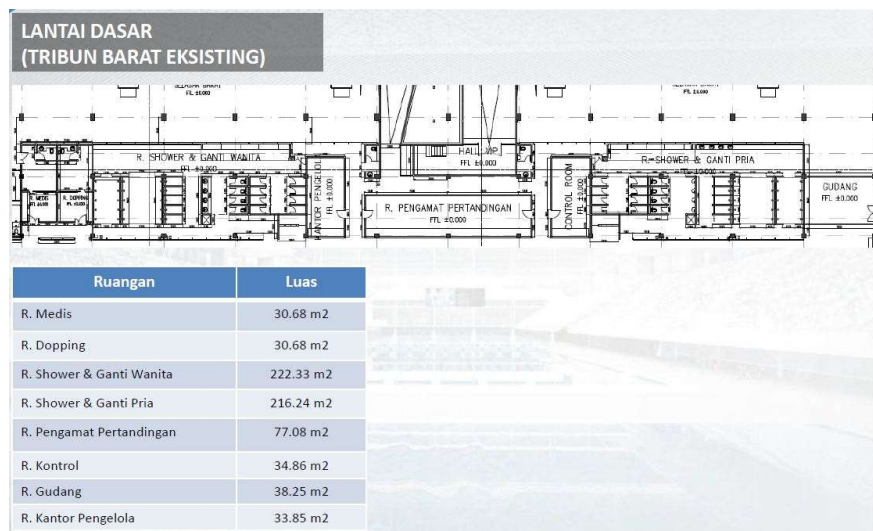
Denah Lantai Basement Stadion Akuatik GBK
